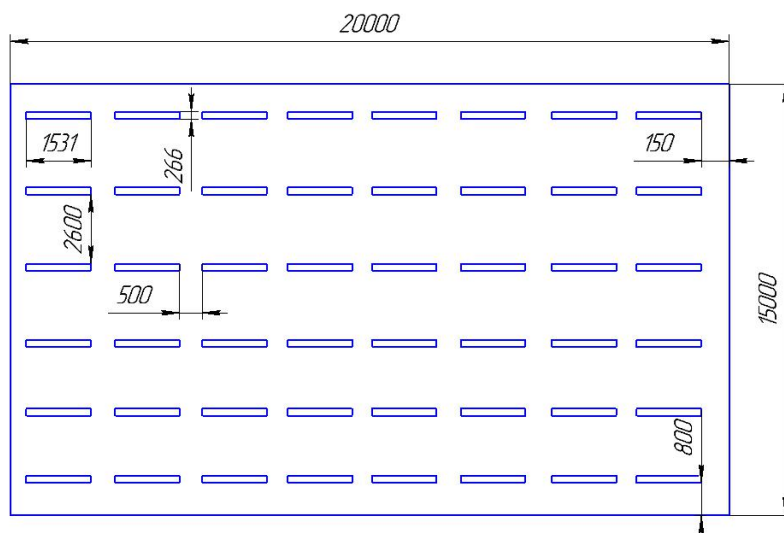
План помещения и размещения светильников с люминесцентными лампами.
